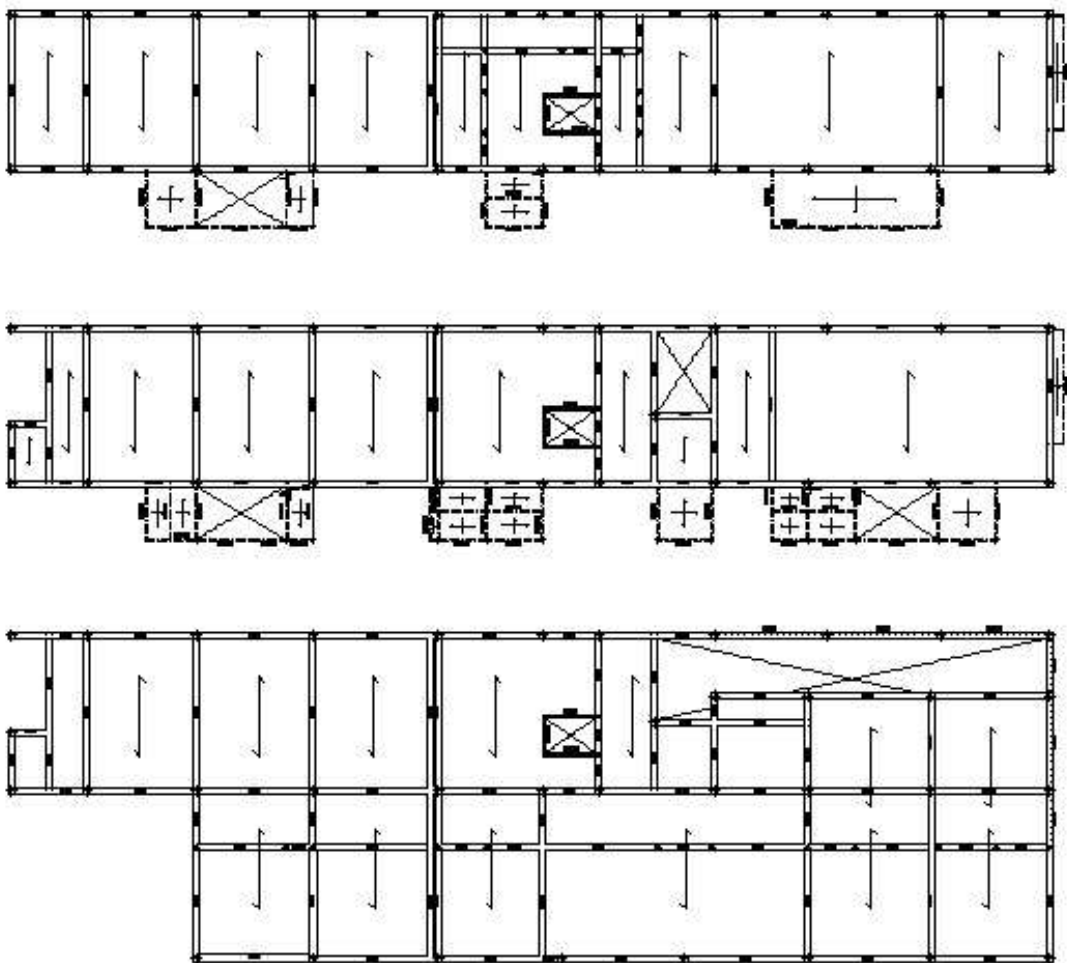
Es mostren les tres plantilles que s'han insertat al Cypecad. Sostre Planta Soterrani, sostre Planta Baixa i Sostre Planta Primera
